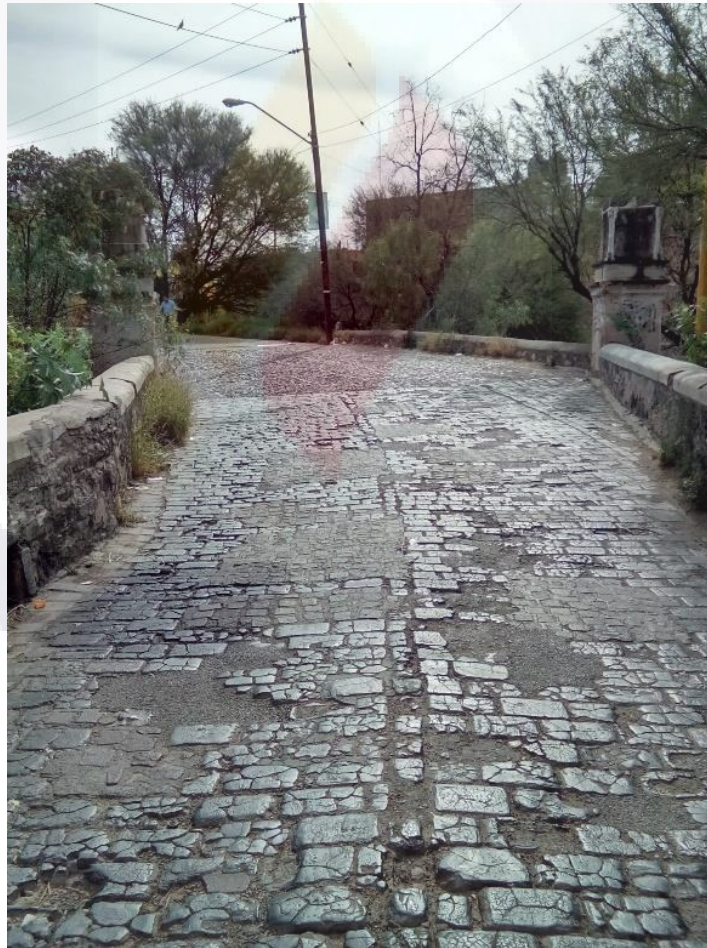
Panorama general actual del pavimento del puente. Fuente propia.
